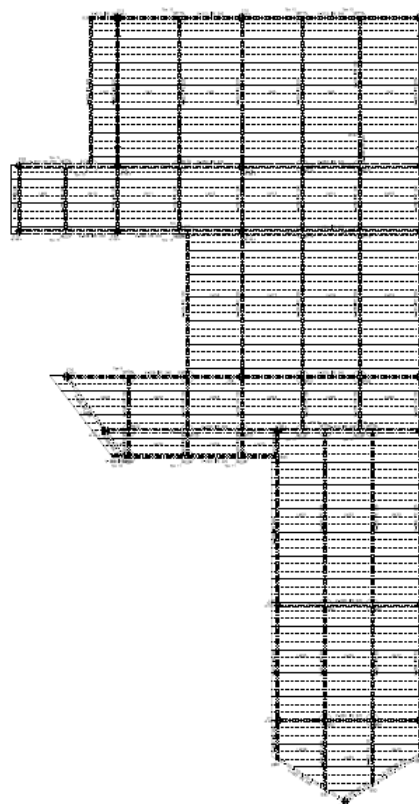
Plano Uniones Soldadas Entrepiso. Colegio. CAJAMAG.
